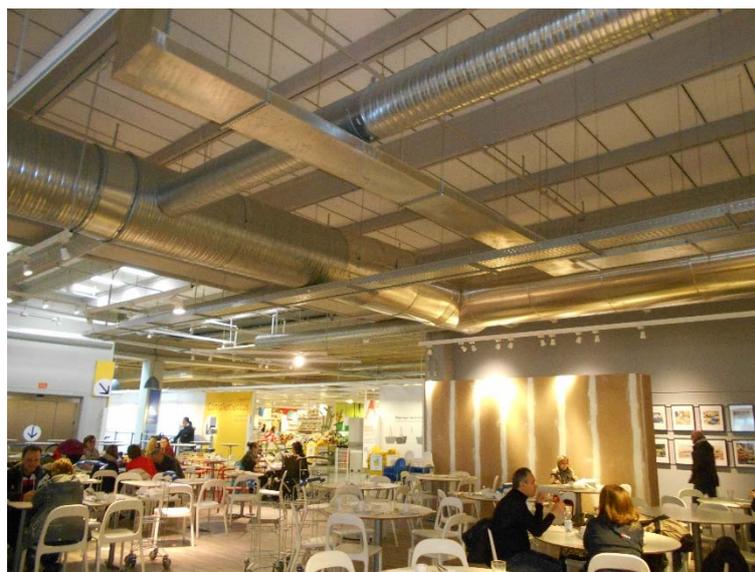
UBICACIÓN DOTs EN ZONA DE RESTAURANTE
